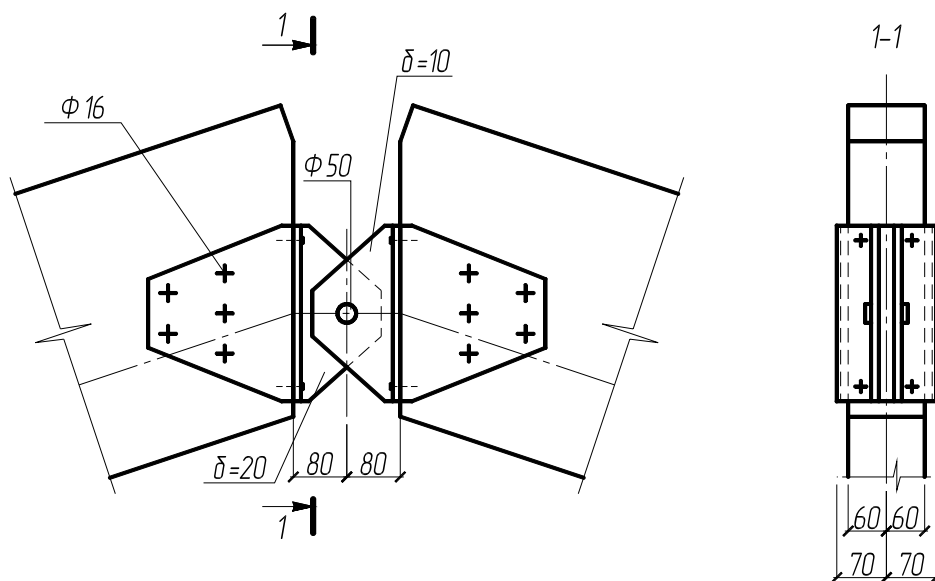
Коньковый узел треугольной арки с клееным армированным верхним поясом
